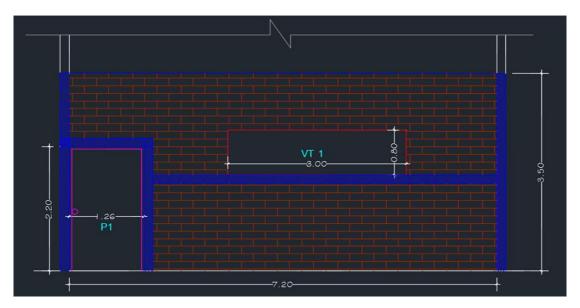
detalle de trabajo de mampostería de bloques de concreto Fuente: Kevin Ronald Armas Padilla
